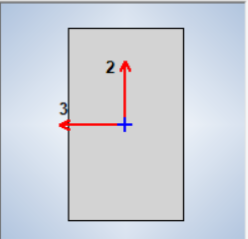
Sección de viga V-C (0.20m x 0.35m)
